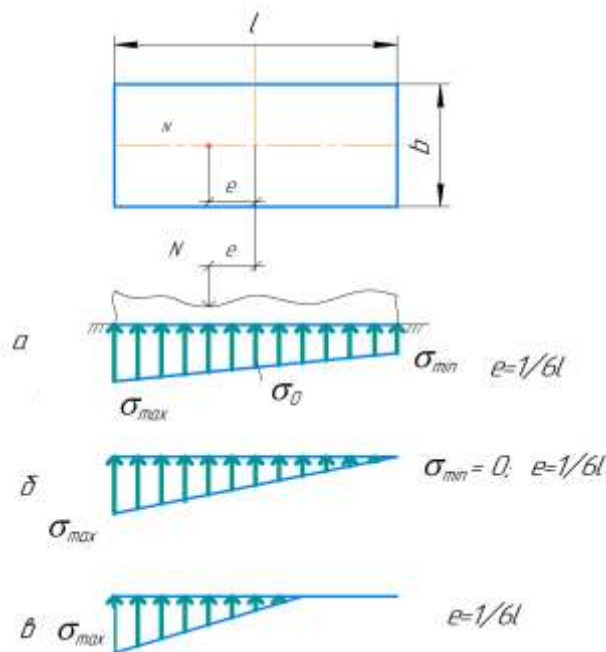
Распределение напряжений по подошве фундамента при внецентренной нагрузке [8]
